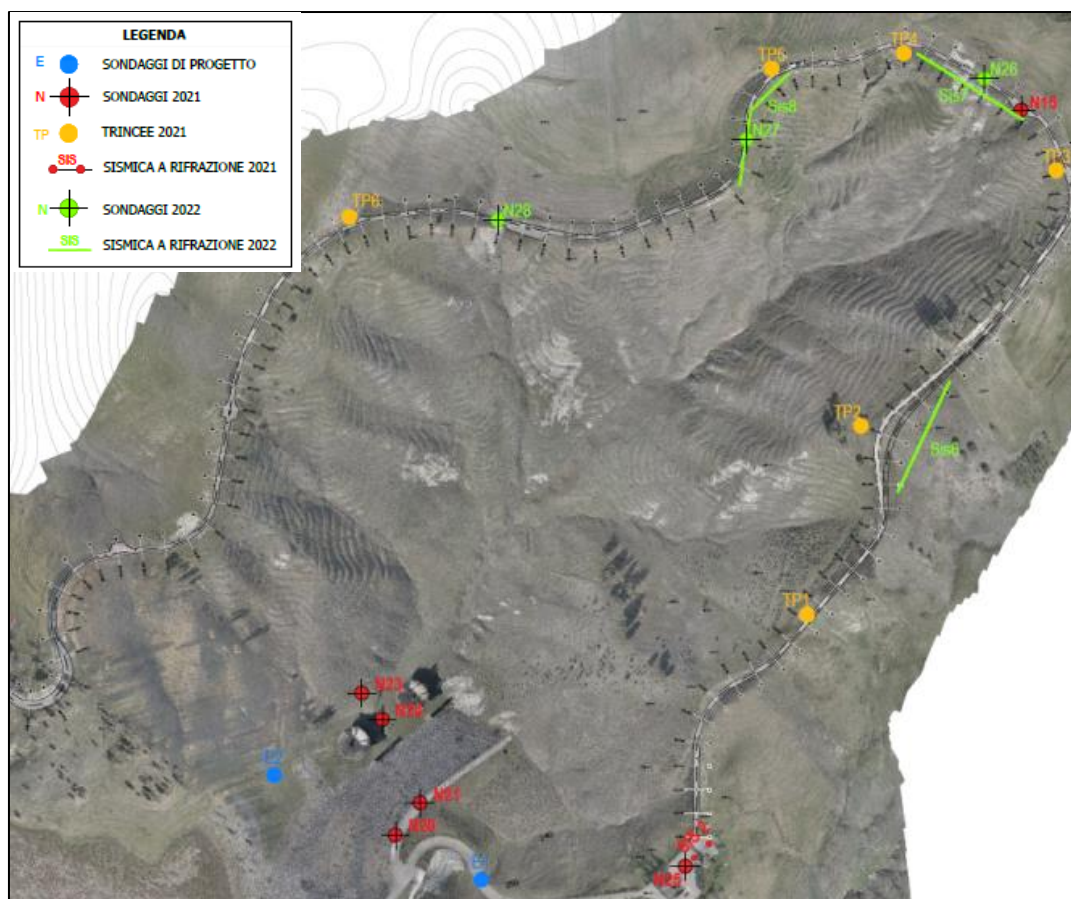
Planimetria con ubicazione delle indagini del 2021 e 2022
